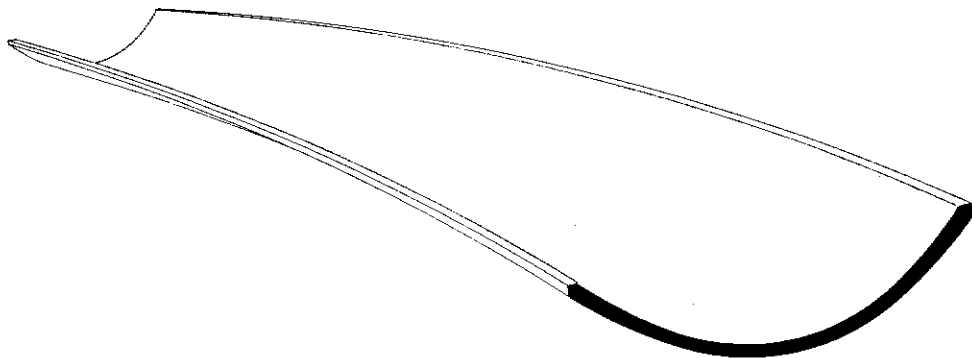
HP-skal: Betonelement fra Norm Beton.
